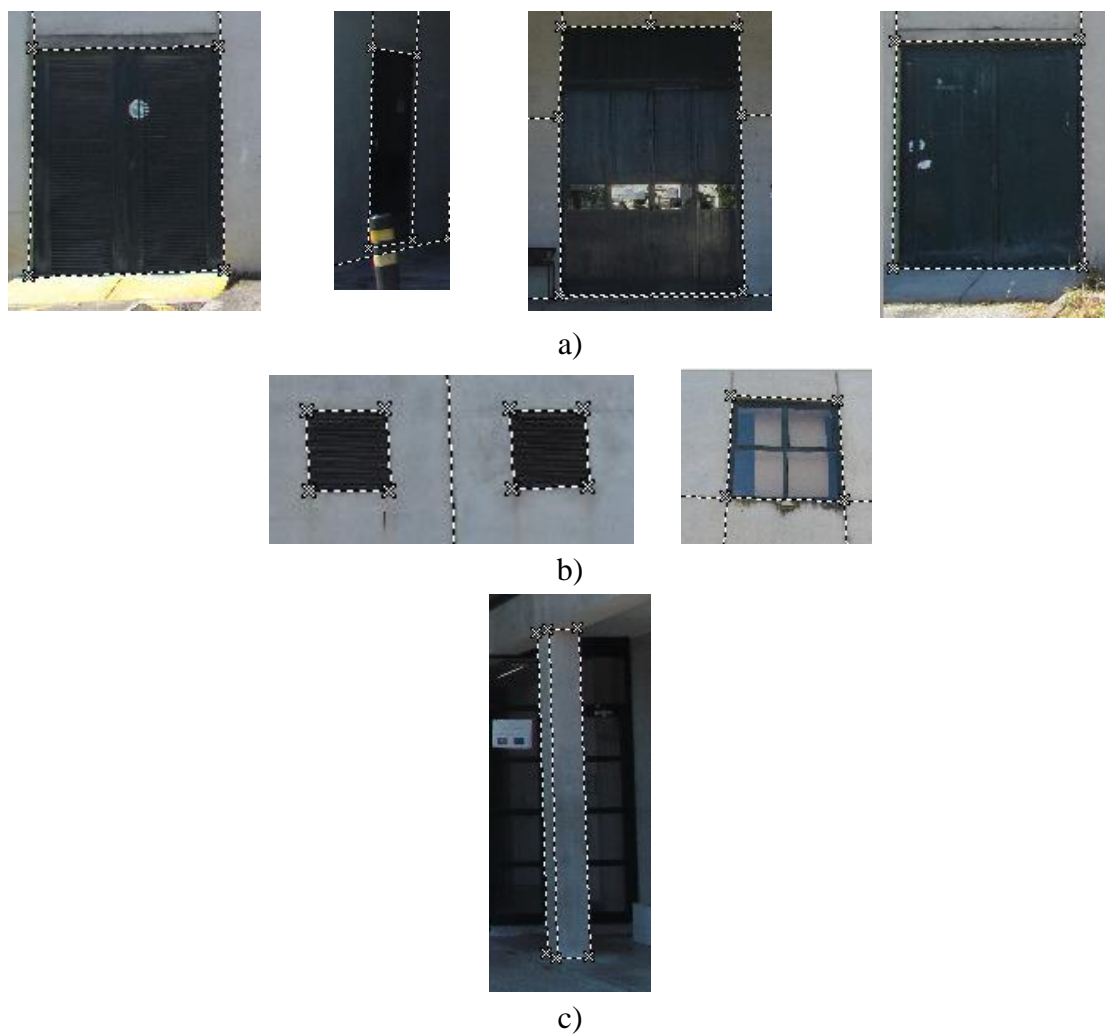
Traçado de a) portas, b) janelas e c) pilar
